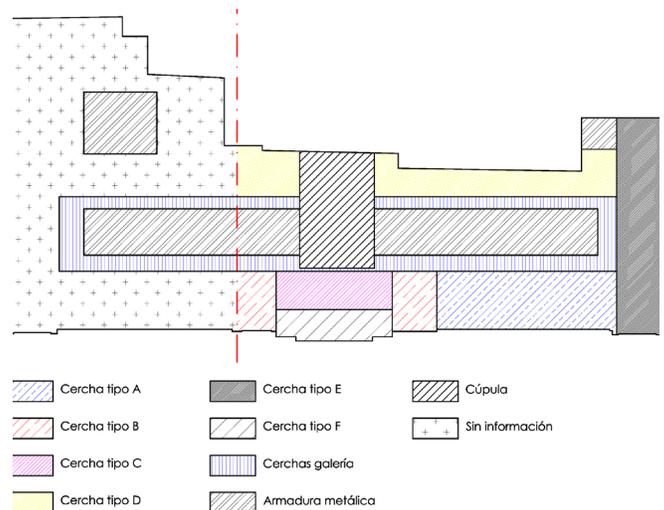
Tipos de estructuras de cubierta en Palacio de Tribunales. Elaboración propia en base a plano MOP033687
